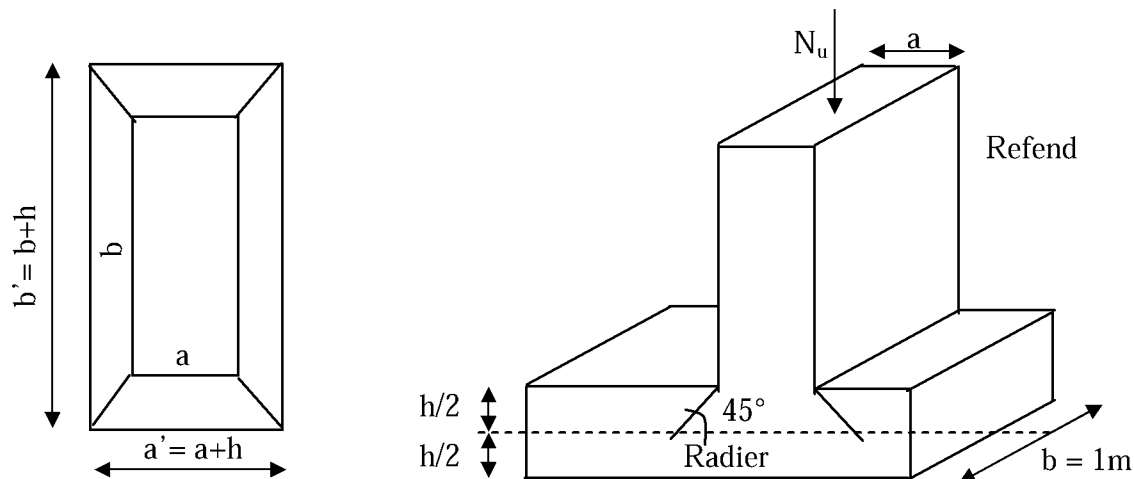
Périmètre utile des voiles et des poteaux.
